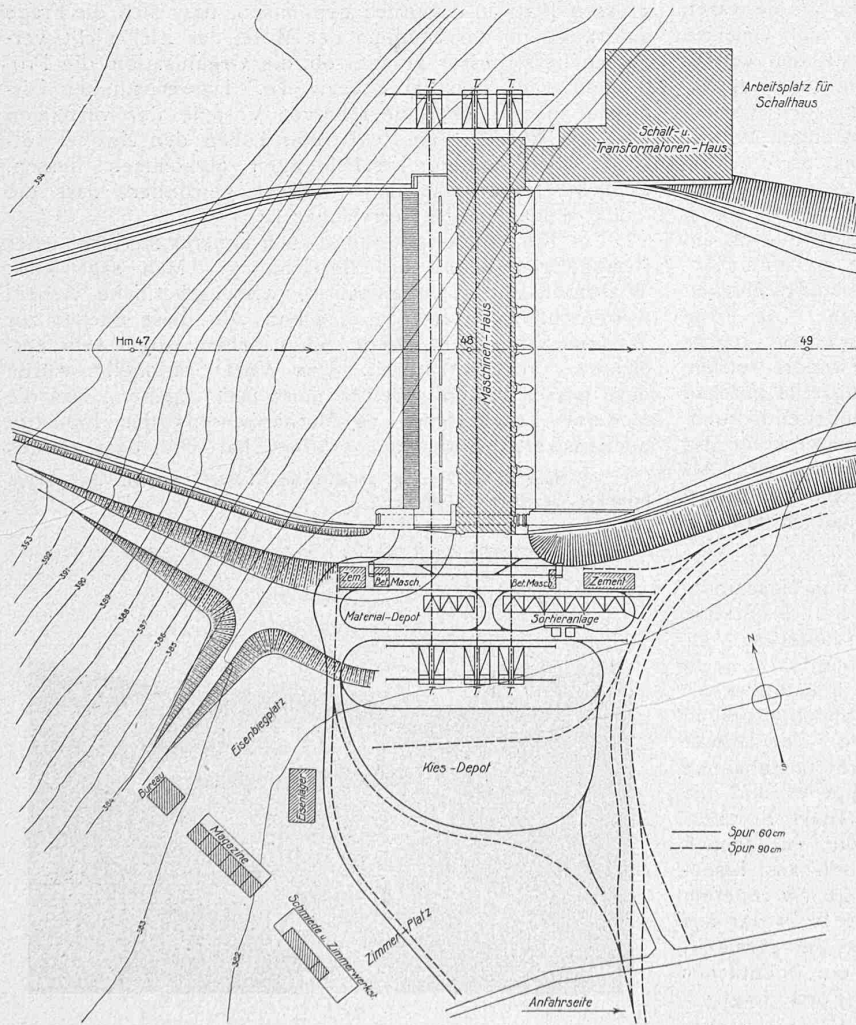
Lageplan des Maschinen- und des Schalldhauses, mit Installationsplatz. — 1 : 2000.
